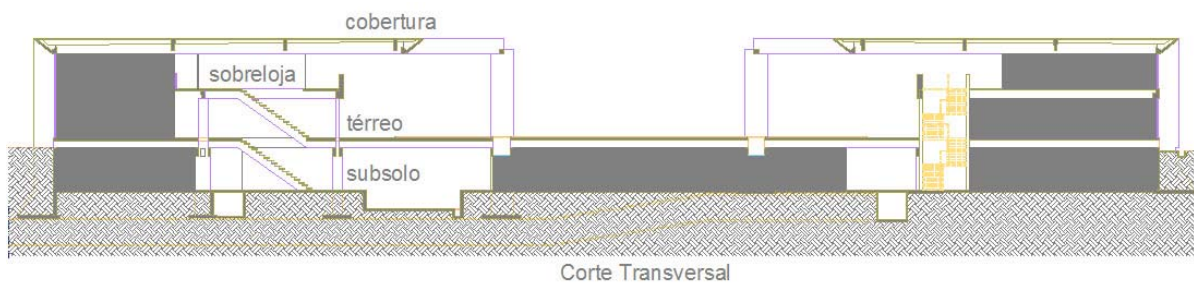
Corte Transversal do ICC (CEPLAN, 2006)
